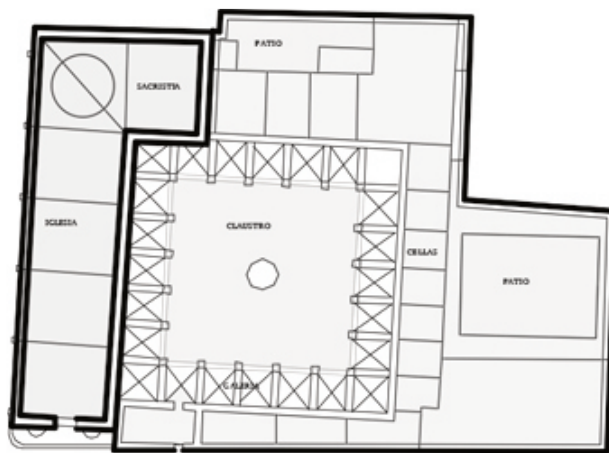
Detalle plano de la planta oratorio San Felipe Neri de Sucre.
